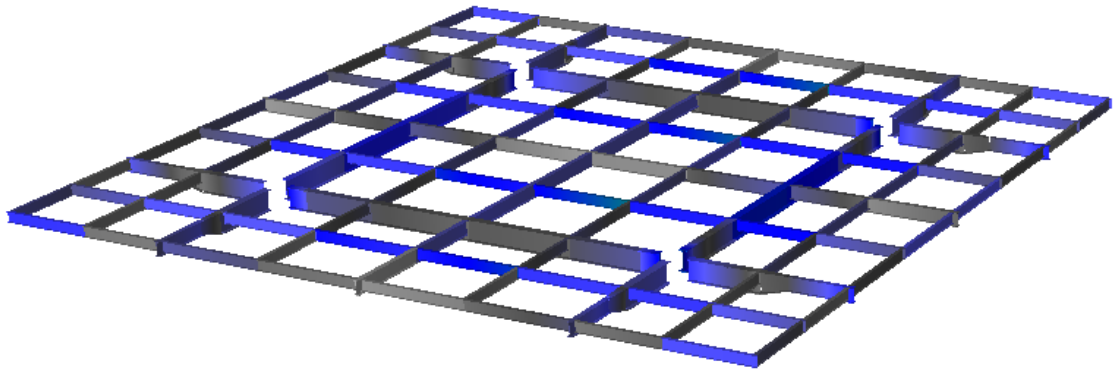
Elementi orizzontali a sezione aperta - impalcato Quota 19 m
